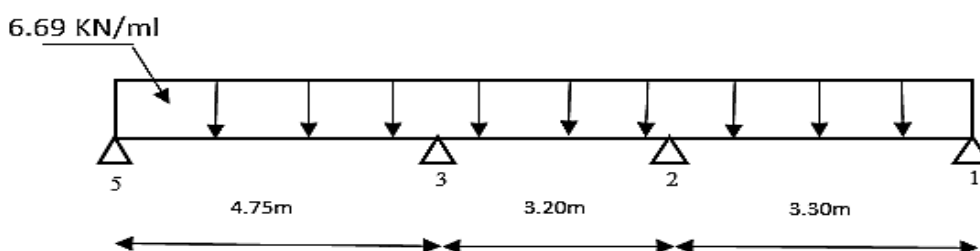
Schéma d'une poutrelle a 4 appuis
